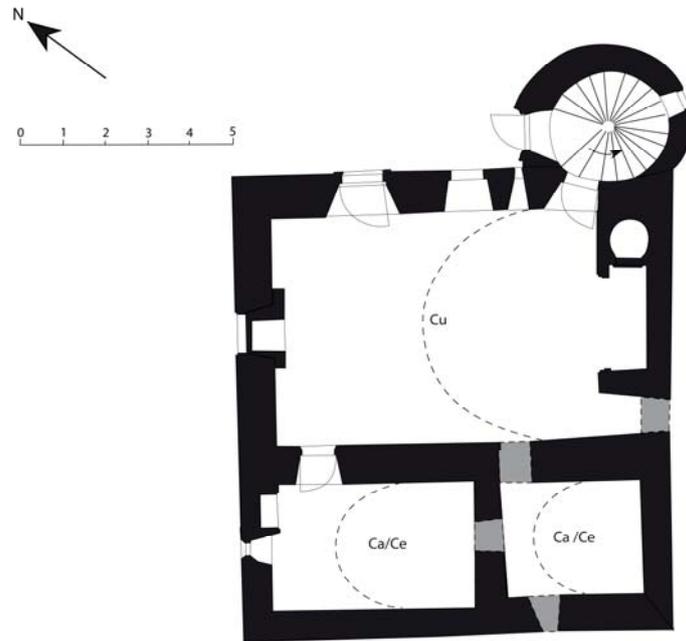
Logis, plan du rez-de-chaussée, état restitué
